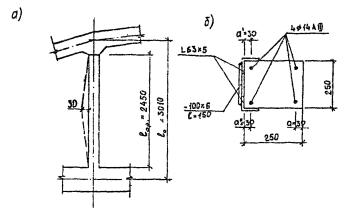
Схема усиления внецентренно сжатого элемента односторонними напряженными распорками:
